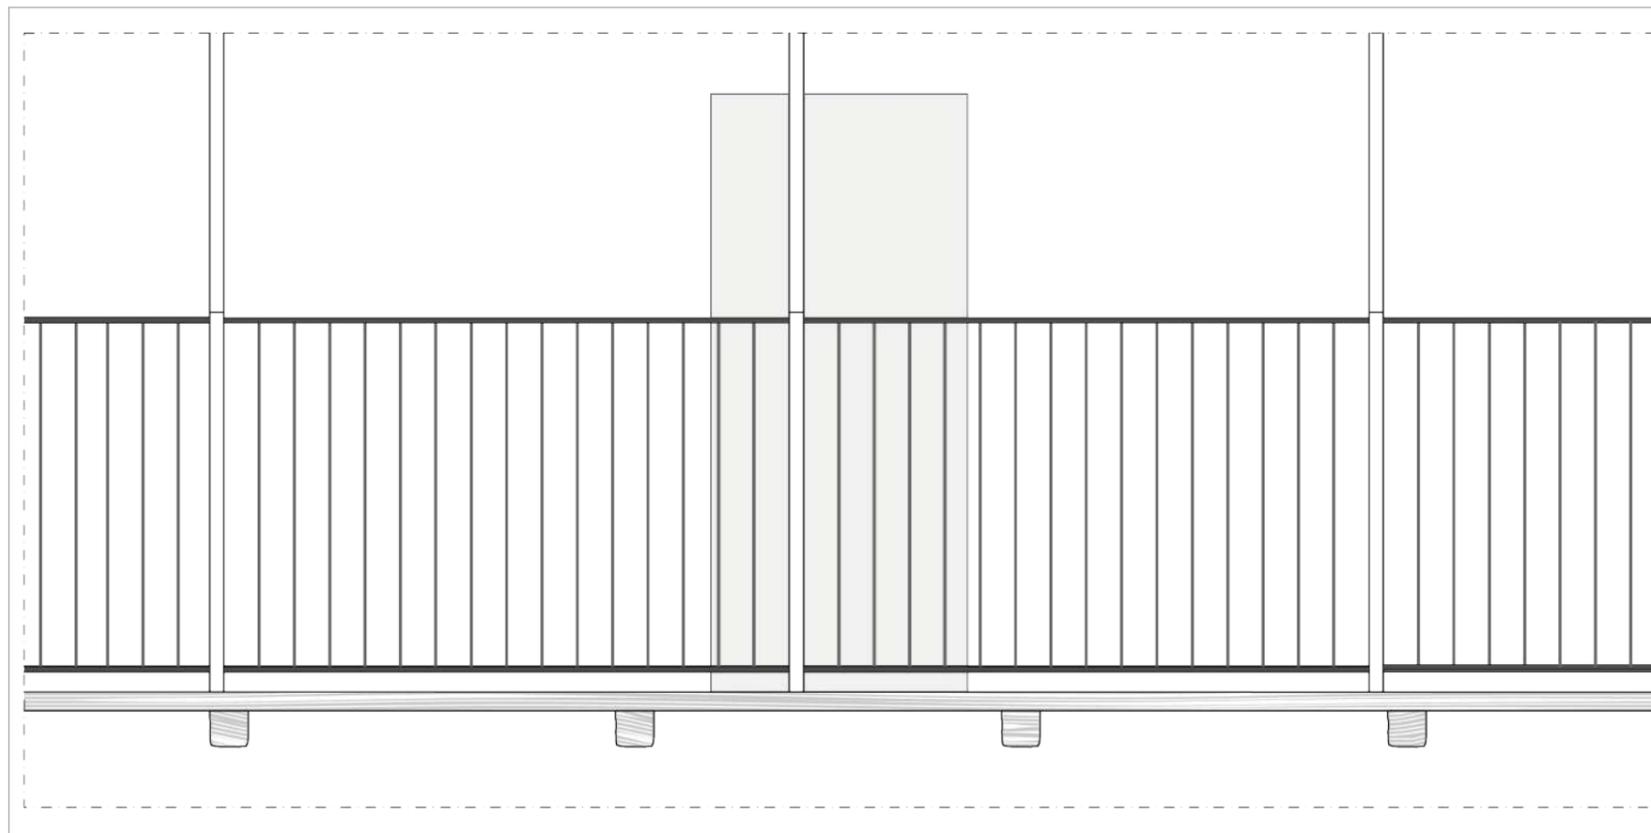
Dettaglio del parapetto del ballatoio dell'edificio 03.
